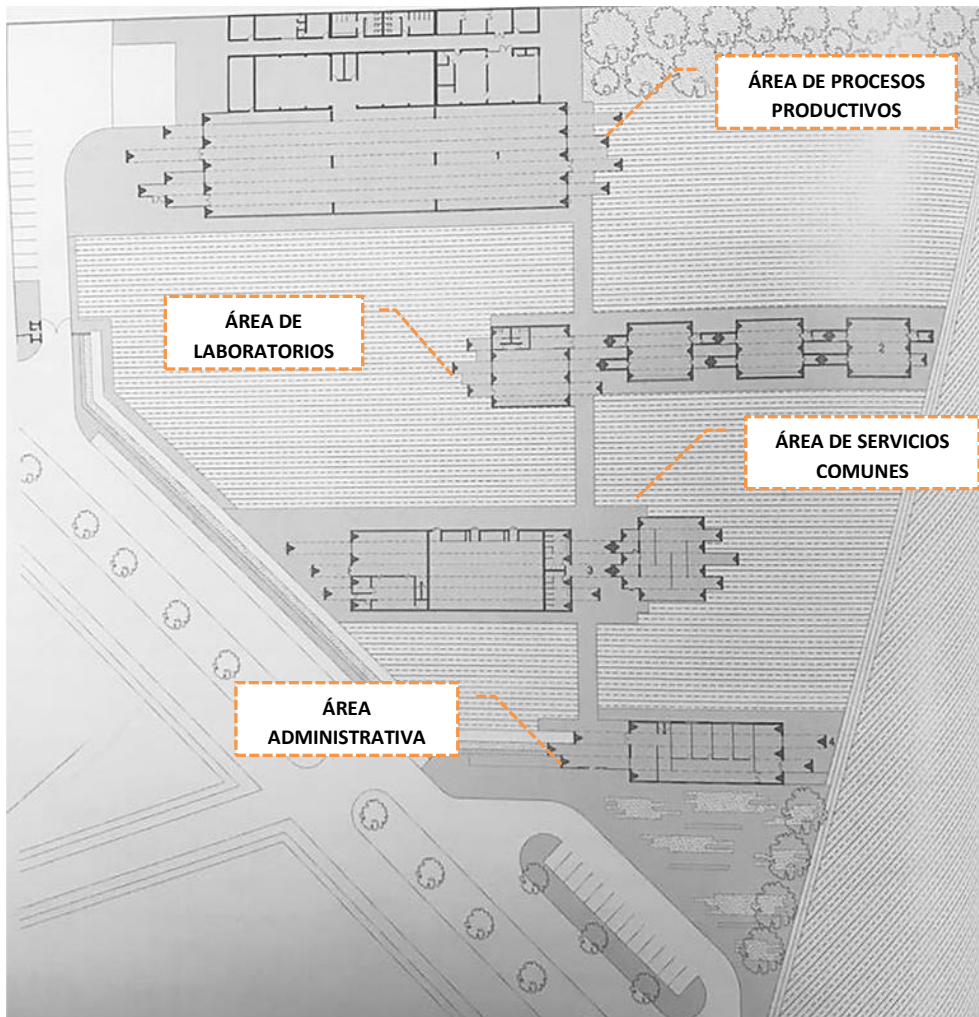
Zonificación del proyecto - Planta primer nivel
